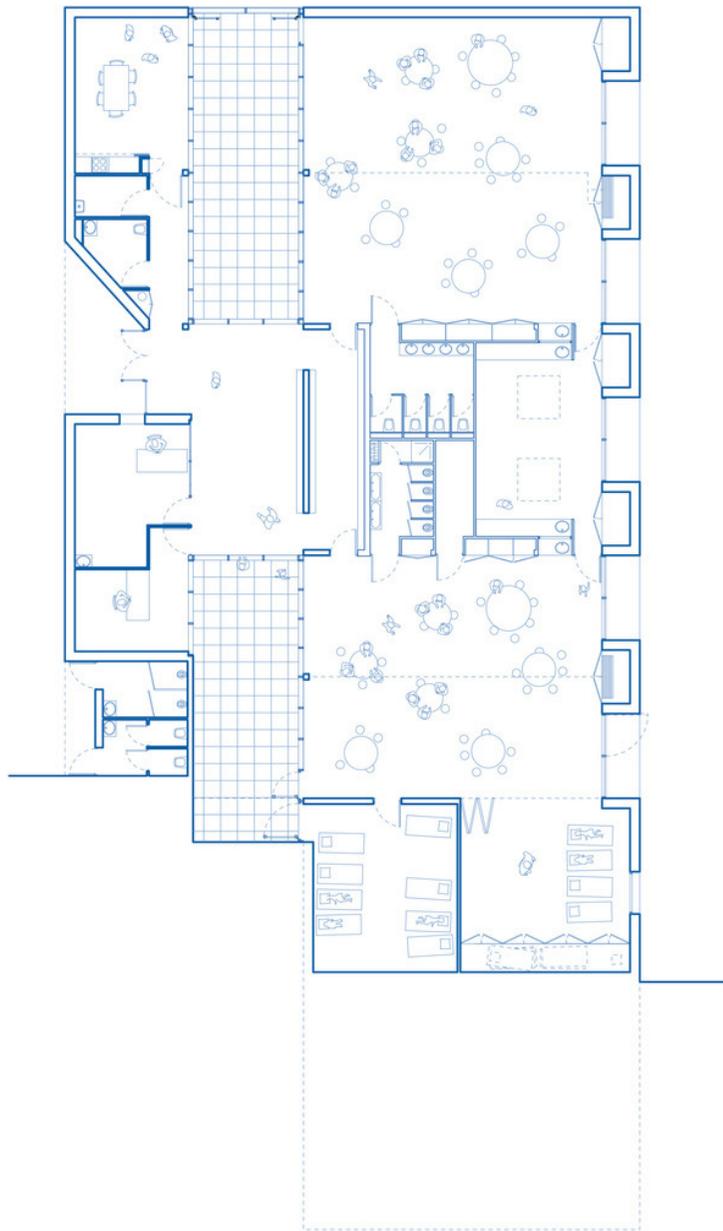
Plantas arquitectónicas - Escuela Elvén
